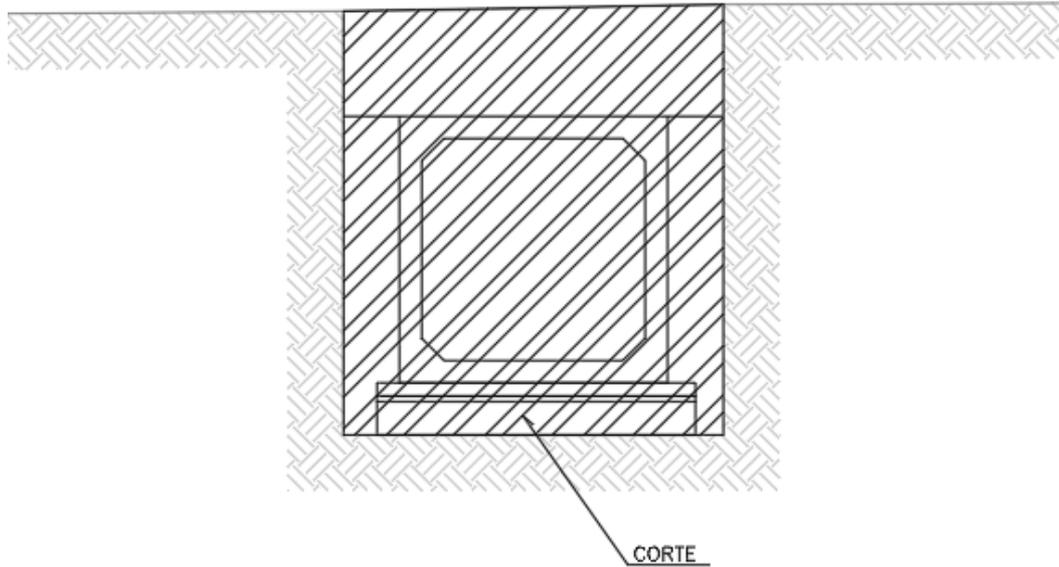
Seção tipo do corte de terraplanagem 3/4
